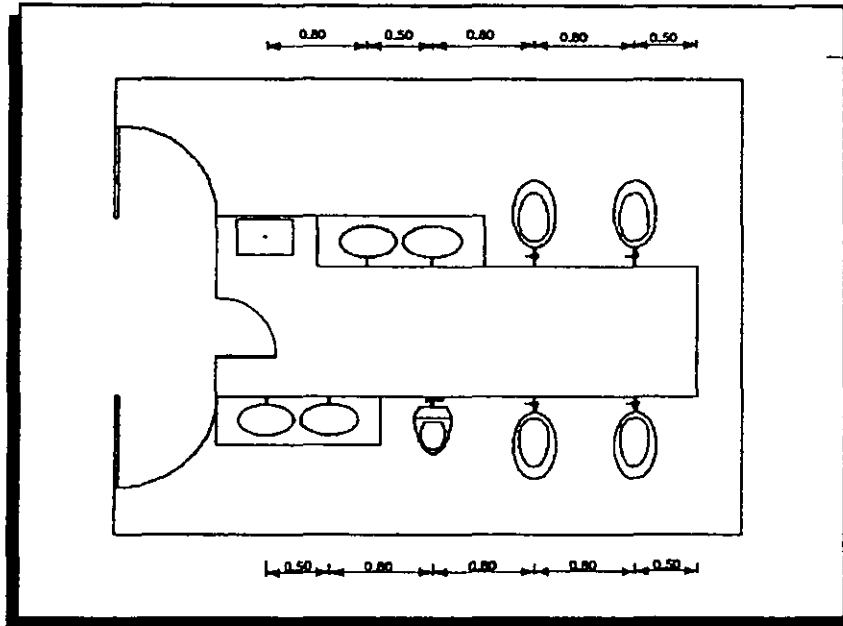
Planta arquitectónica de los sanitarios del ejemplo 5.1.
